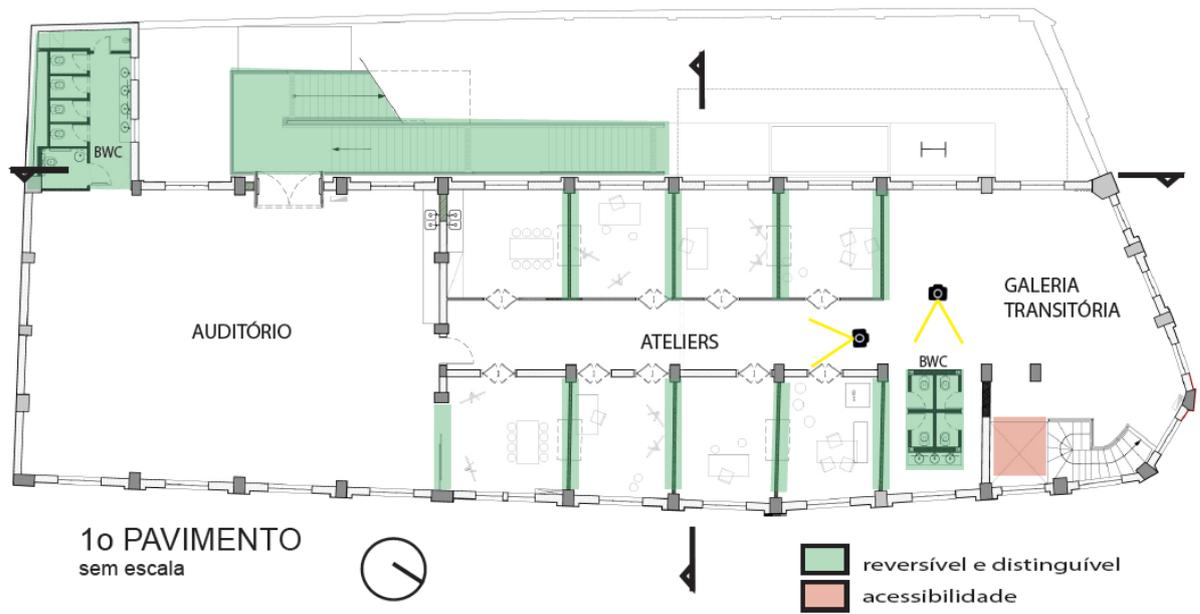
Planta do Primeiro Pavimento do Centro Cultural *Red Bull Station* (ARCHDAILY, 2013)
